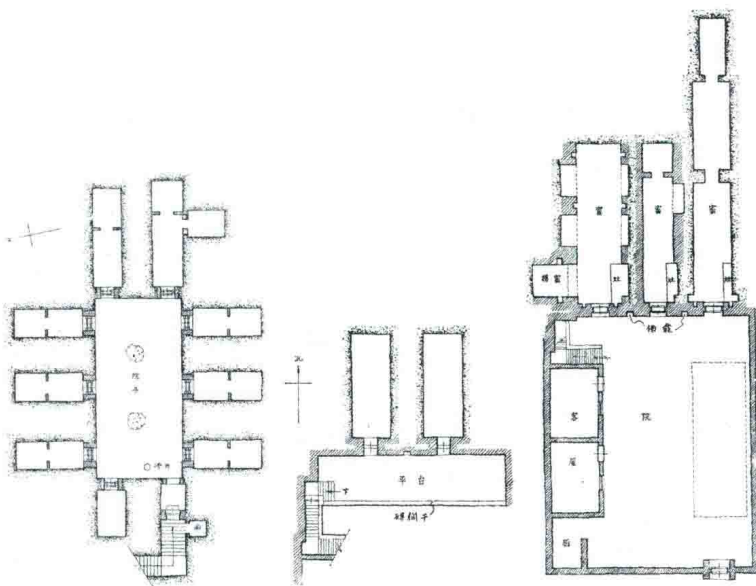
河南巩县窑洞建筑平面布置图¹¹⁾
